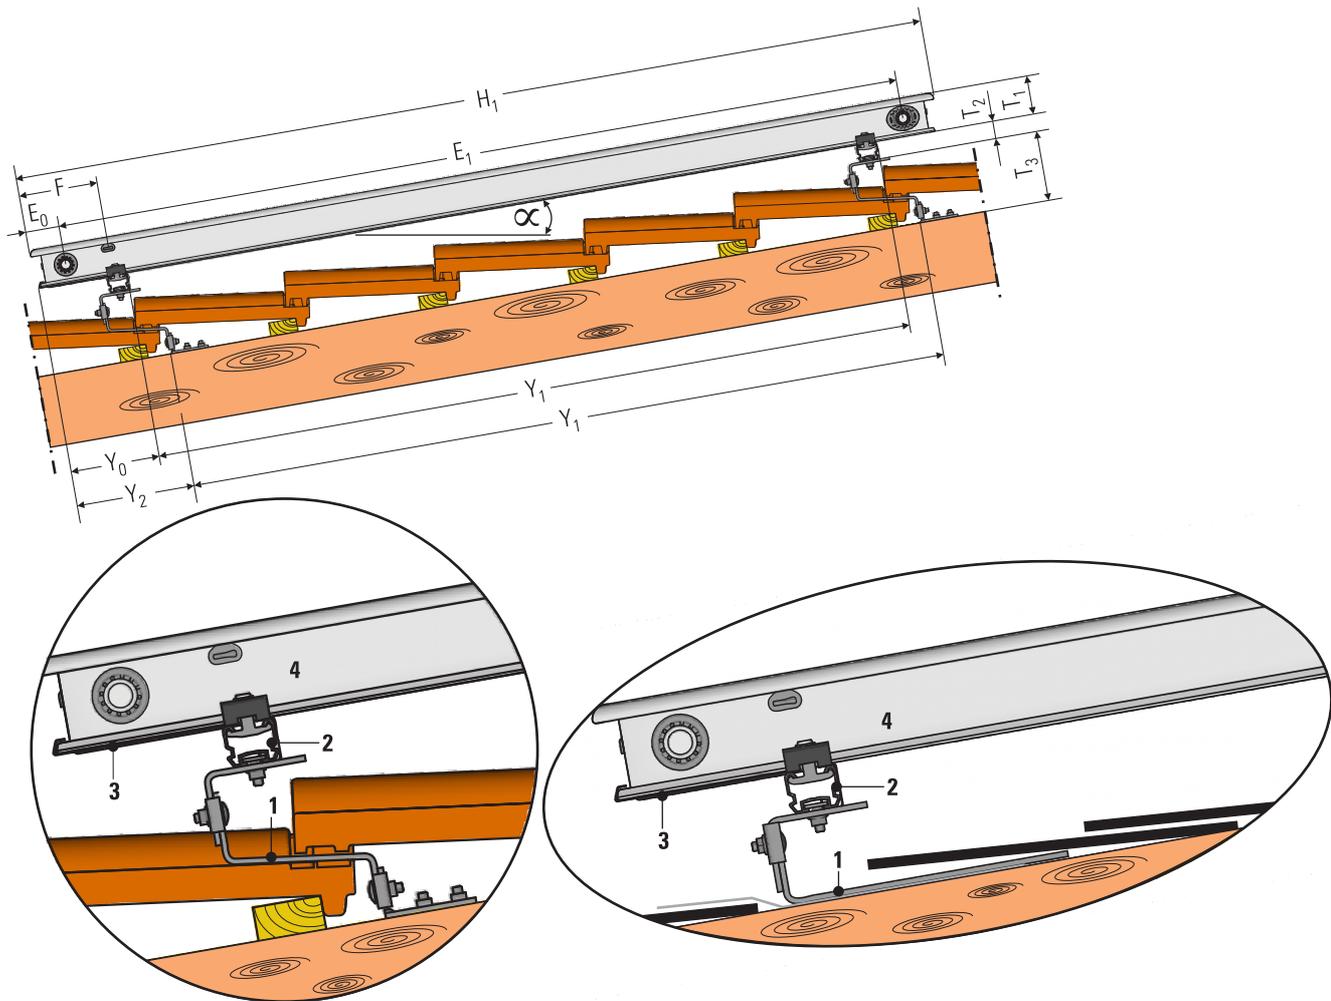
Dimensions principales d'un champ de capteurs d'Installation solaire pour un Capteurs solaires - Montage sur toiture (représenté à l'exemple d'un capteur plan V26P en système Drain Back)
